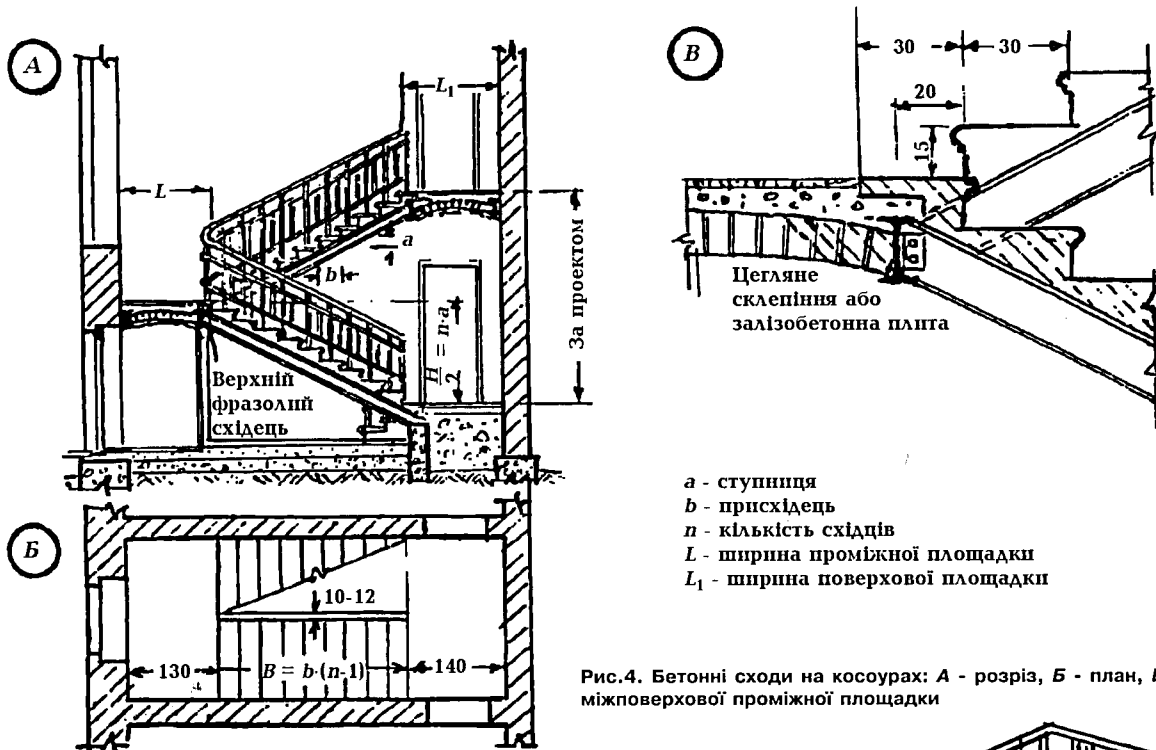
Бетонні сходи на косоурах: А - розріз, Б - план, В - деталь міжповерхової проміжної площадки
